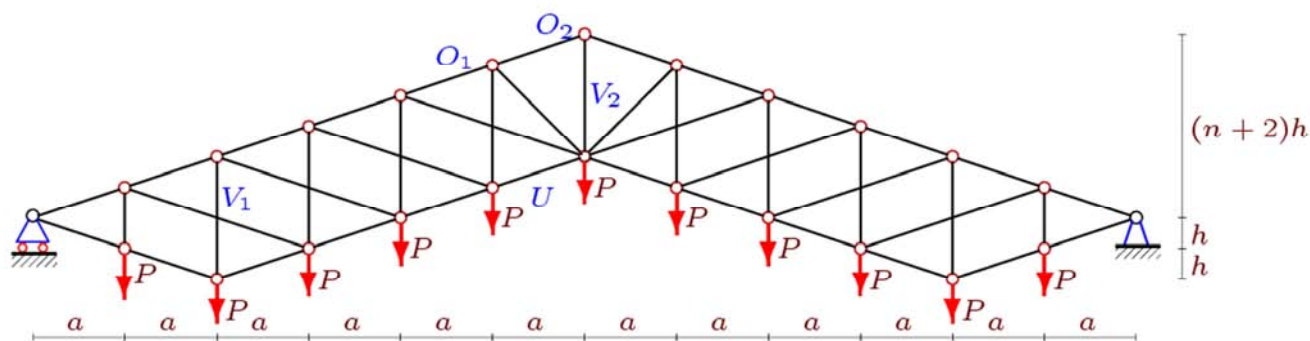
Нагрузка по узлам нижнего пояса, n=4
